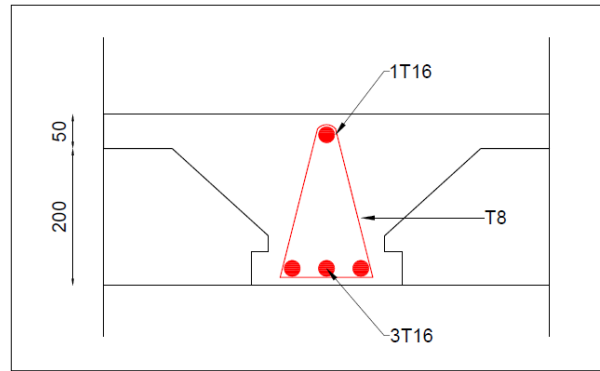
Schéma de ferrailage de la poutrelle étage courant.
